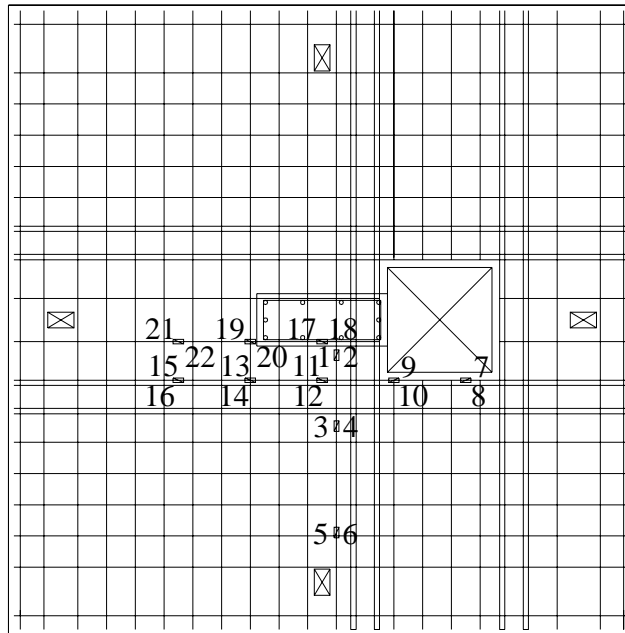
Posicionamento dos extensômetros da laje L2
